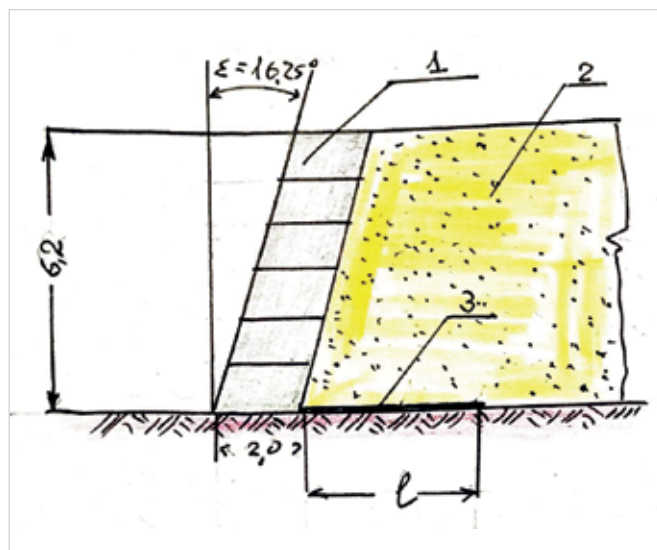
Схема присоединения геосинтетической ткани к нижнему блоку подпорной стены устоя моста
